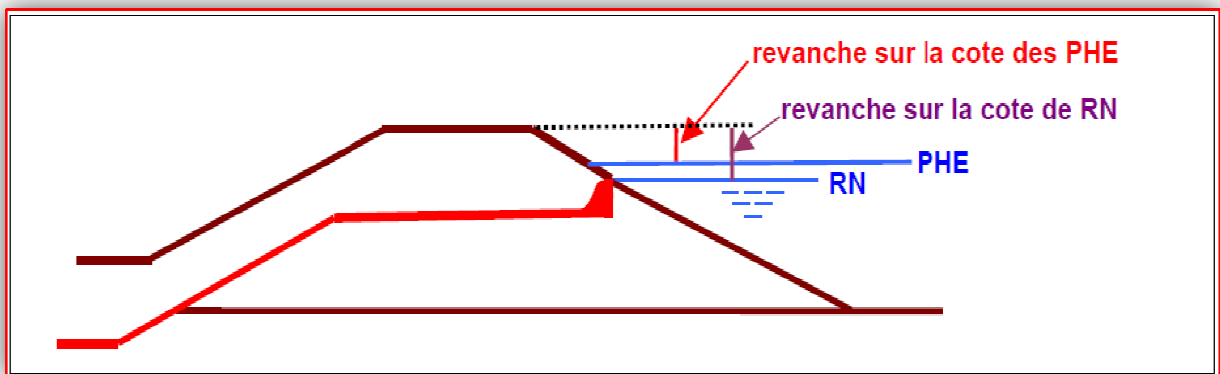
Revanche sur les PHE ou sur la RN pour un barrage non équipé d'un mur pare-vagues
